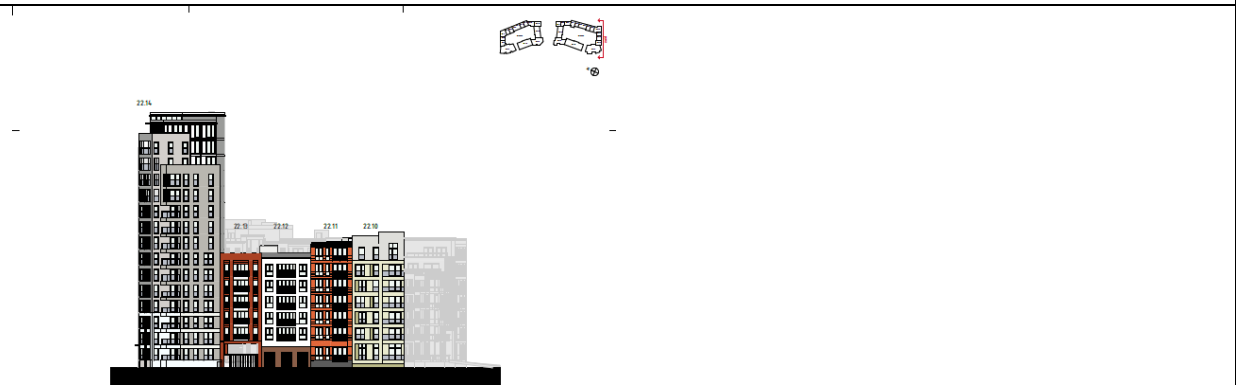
D: Oostgevel (Toren 23,) Blok 23 en Blok 22 (, Toren 22) – tekening nr. 122, d.d. 23-3-2017
